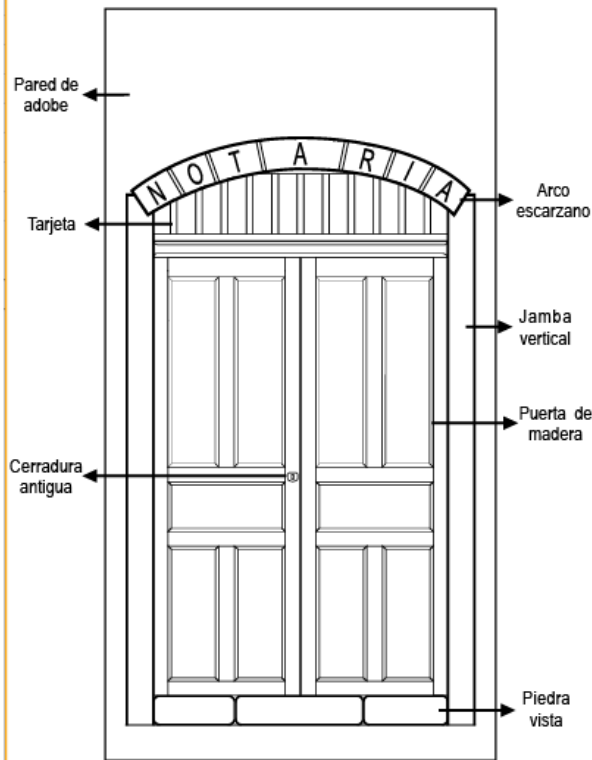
En la ilustración se observa el ingreso principal al inmueble, en este caso, la planta baja de la vivienda solía ser usado como la notaria del cantón.
